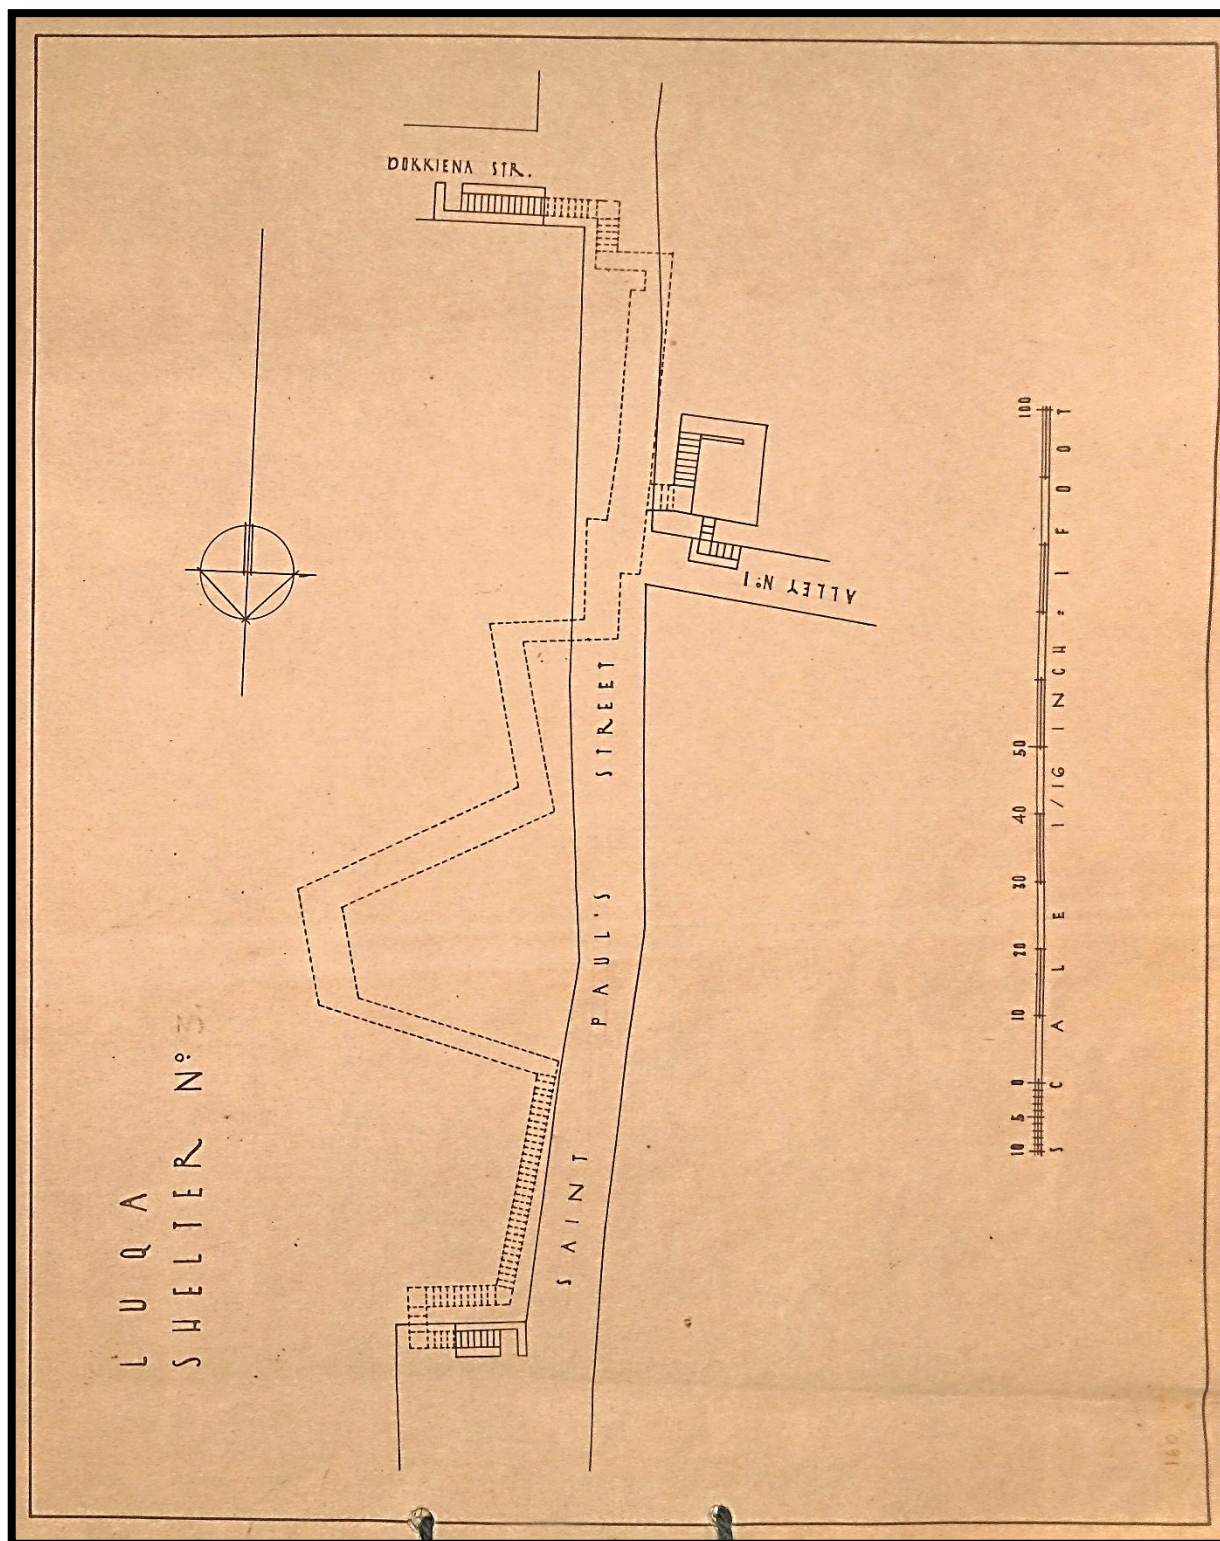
Planta do Abrigo nº3 "Saint Paul's Street – Alley nº1"
